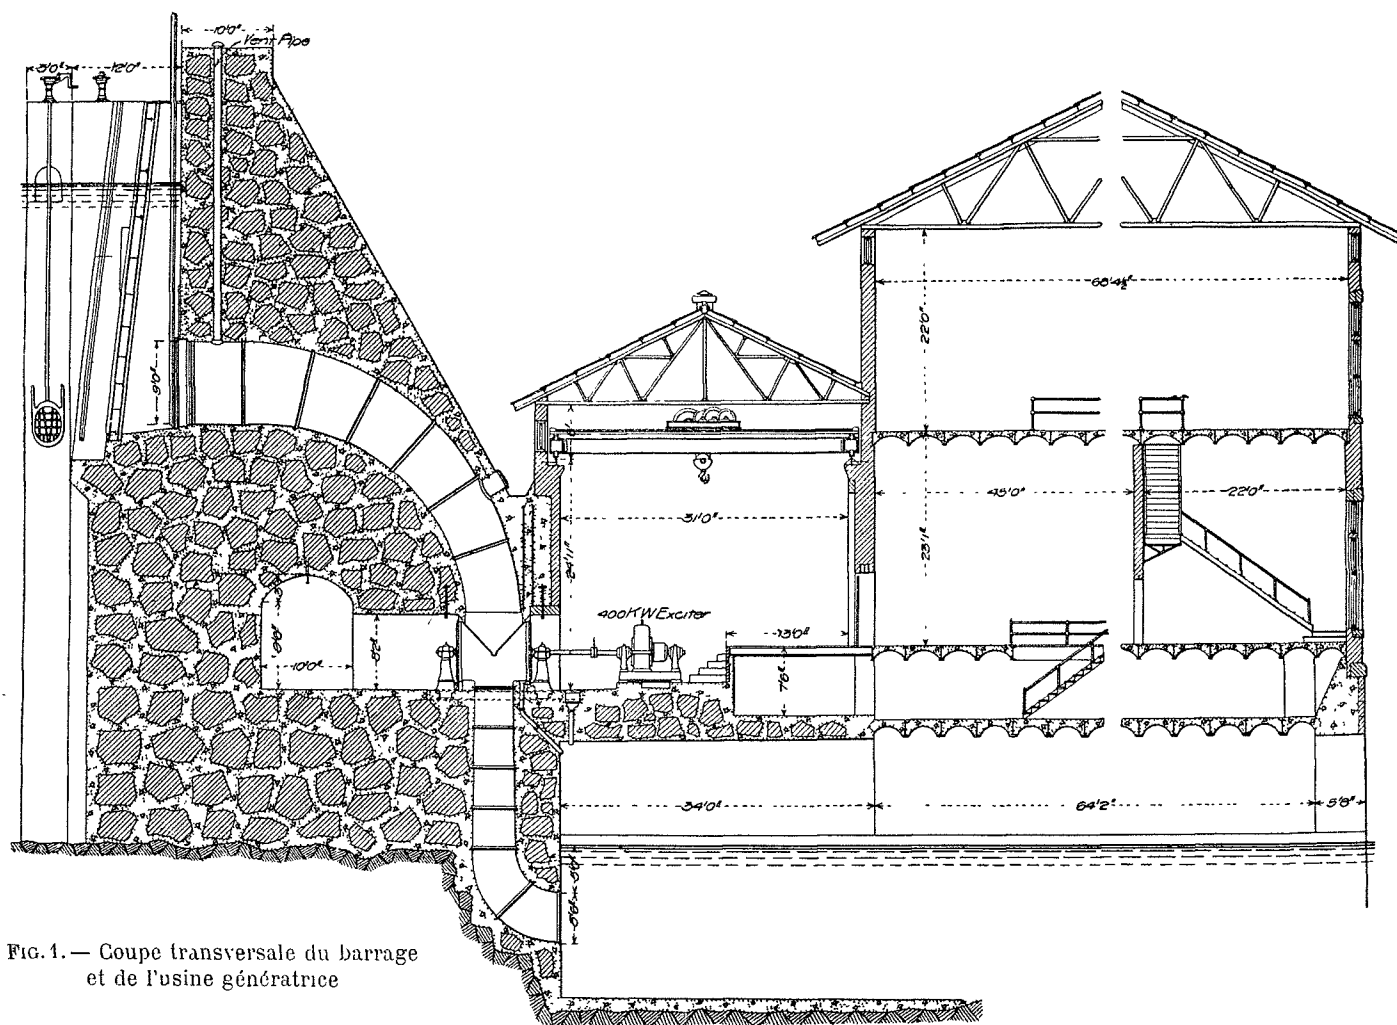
Coupe transversale du barrage et de l'usine génératrice
